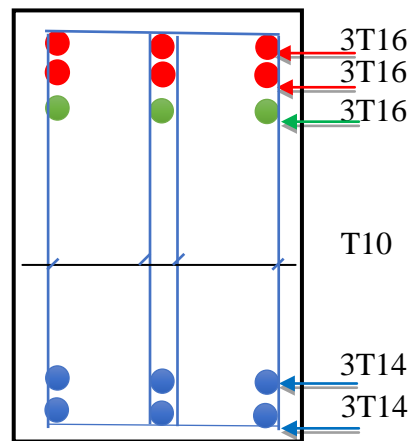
Ferrailage de la poutre de libage (sens longitudinal)
